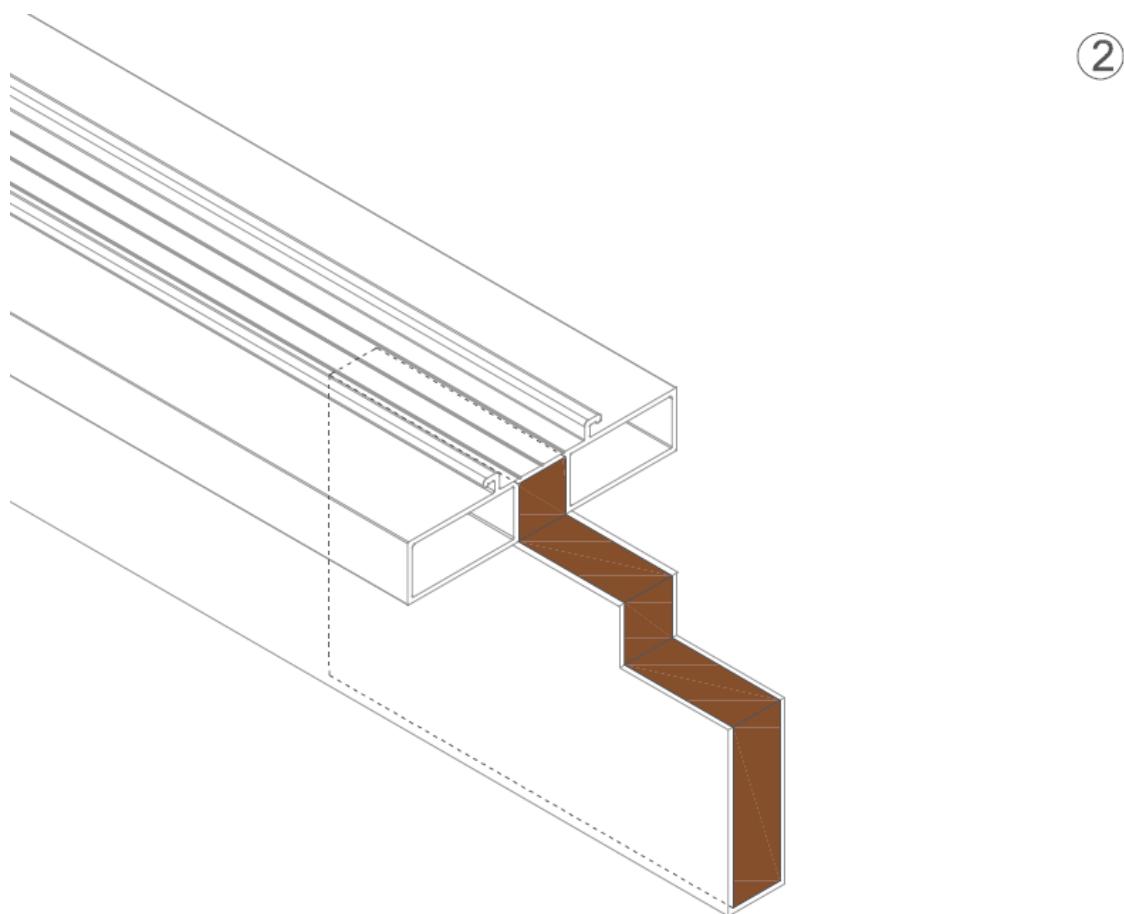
Solução Final – Pormenor do reforço em madeira no perfil transversal.
